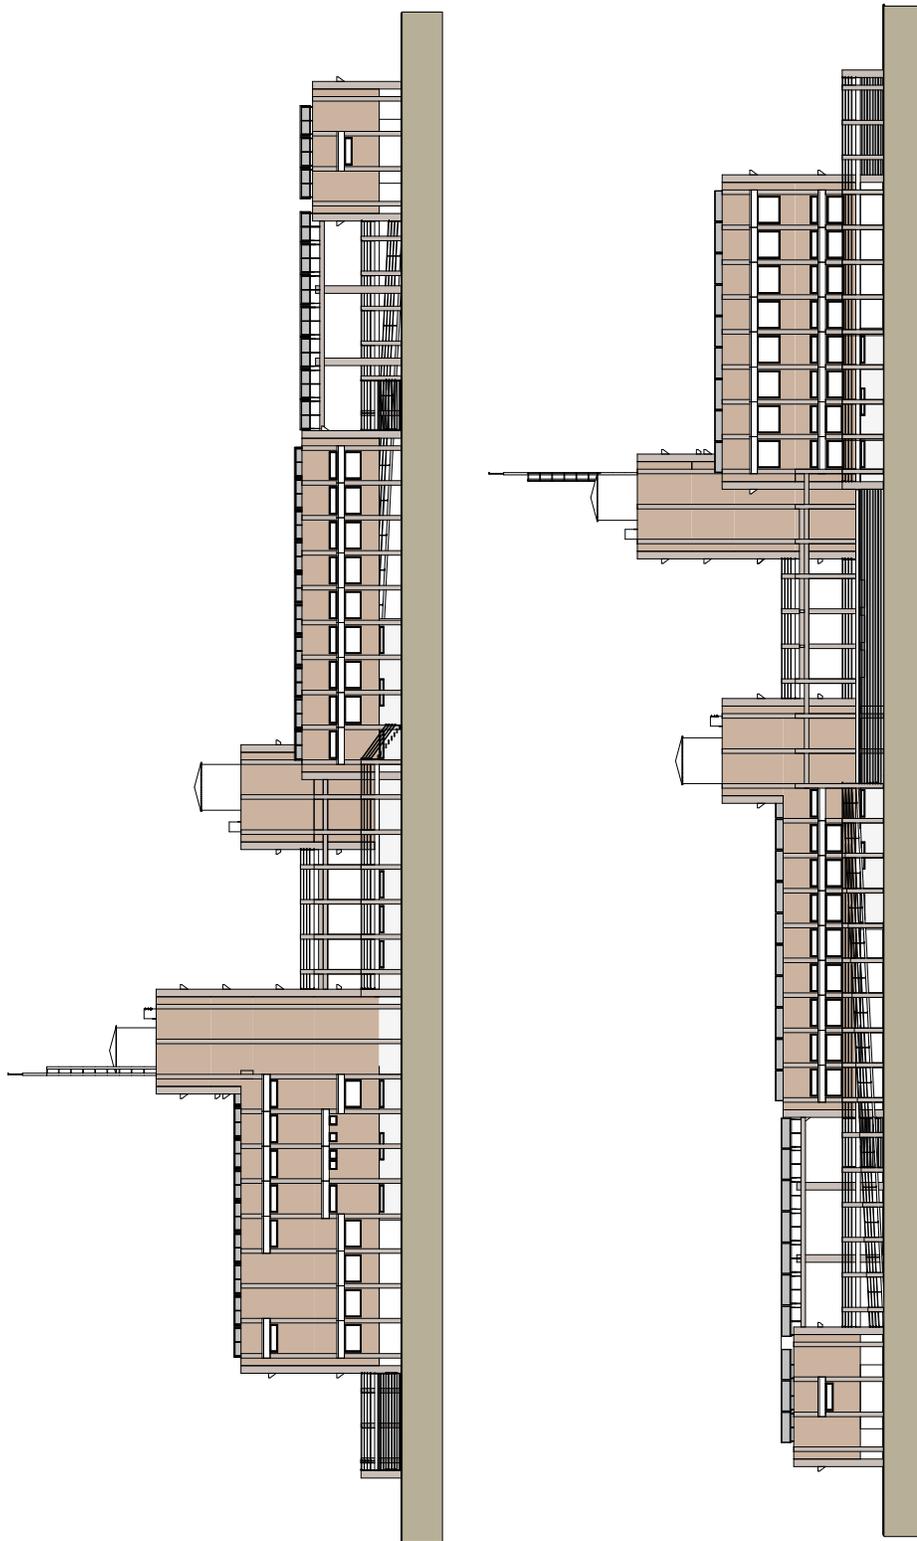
Elevación Norte y Sur (Fuente: elaboración propia)
